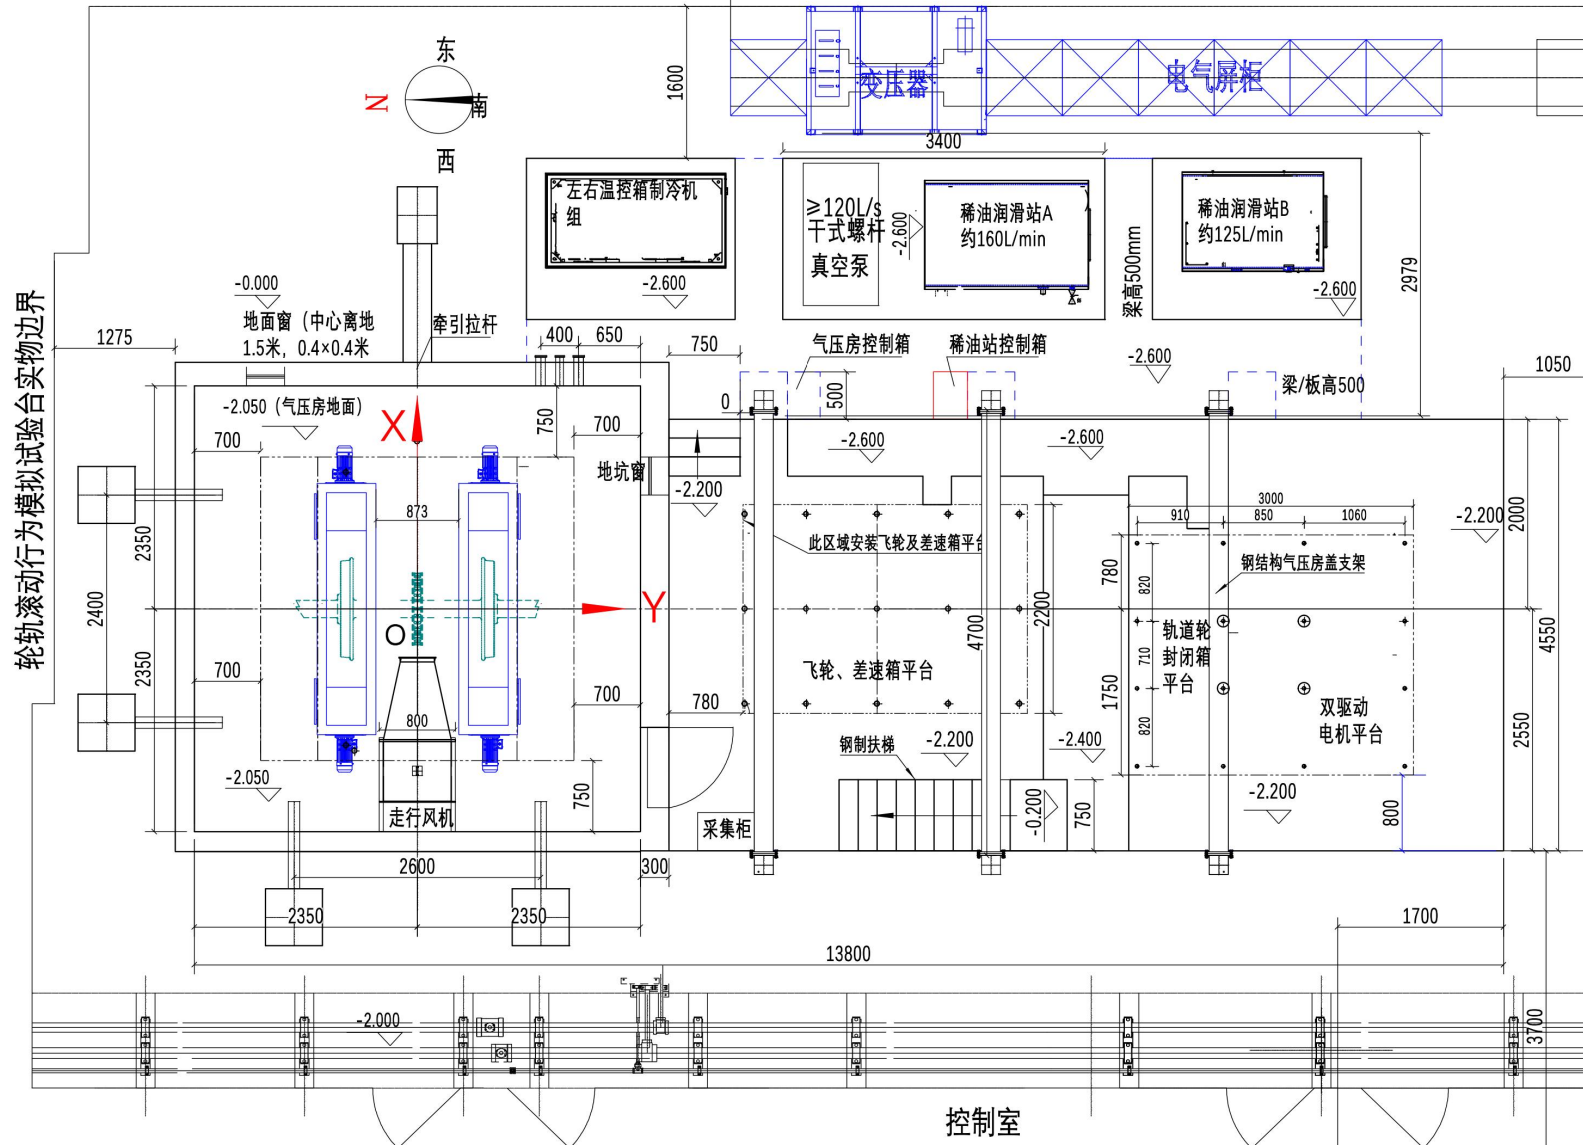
黏着试验台平面布置图 (左边正方形为低气压房)
